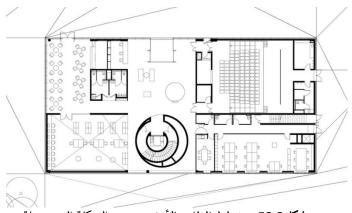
مخطط الطابق الرابع المرجع : archdaily.com
